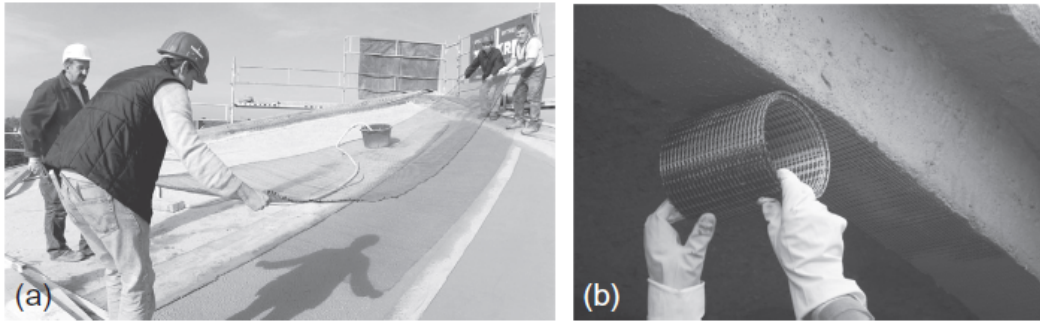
Renforcement par des TRC : (a) Coque en béton armé [2] et (b) Poutre en béton armé [3]
